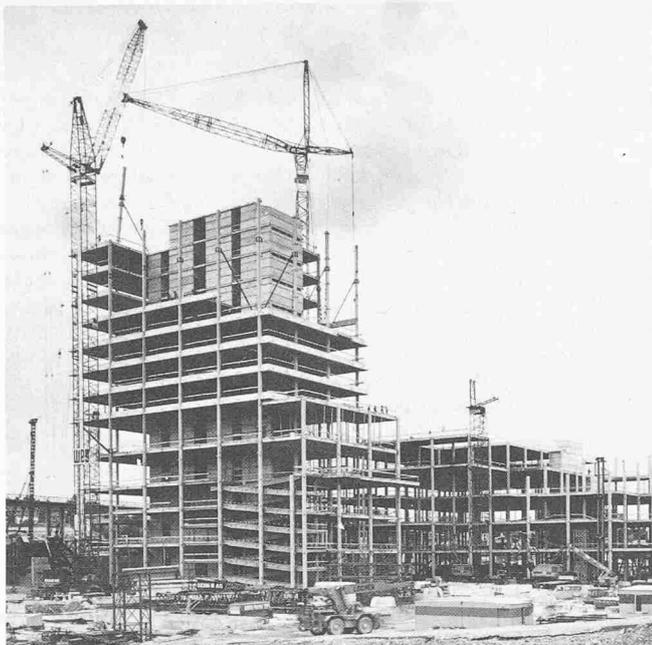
Montage Einkaufszentrum Wallisellen. Links Hochhaus mit vorfabriziertem und vorgespanntem Kern
